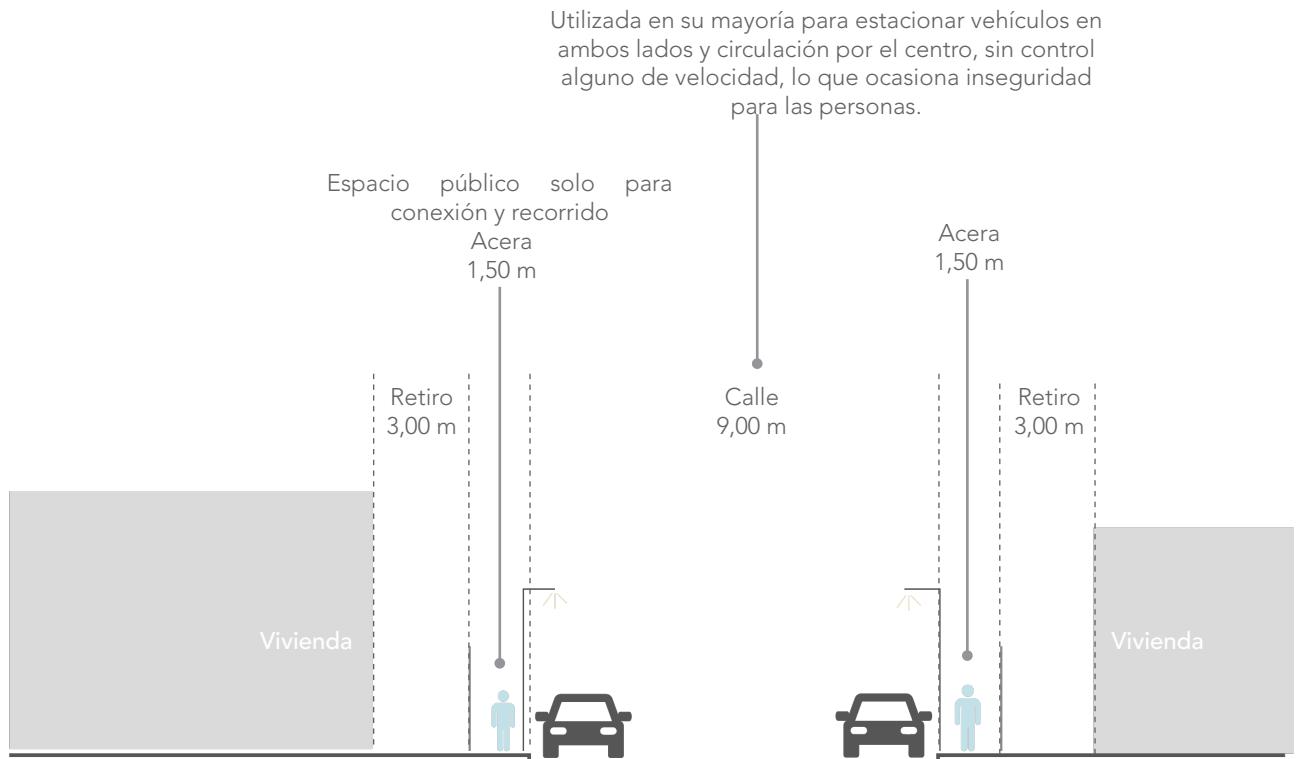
Sección de vía tipo del barrio Las Pitás II.
